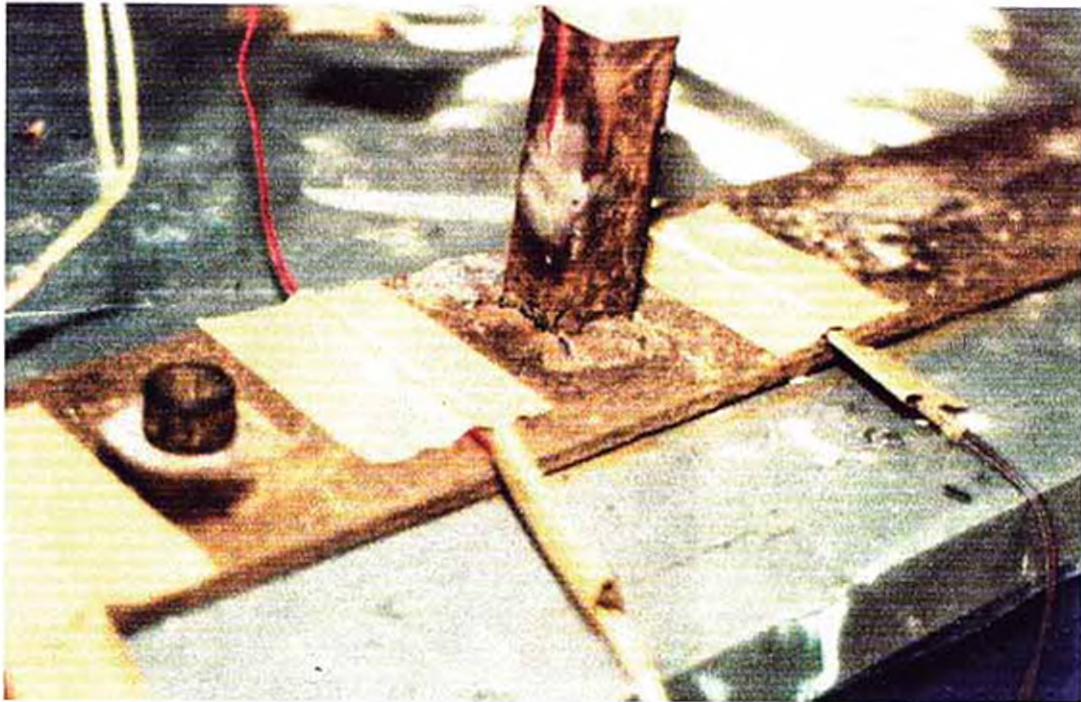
Instrumentos utilizados en el ensayo
